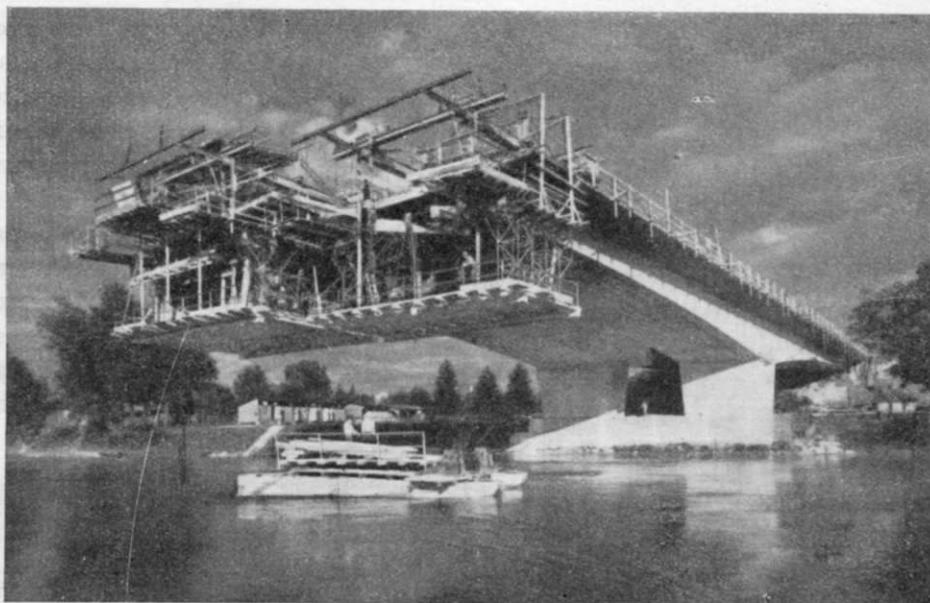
Ponte Ring Ulm: ponte a telaio, Costruzione ad avanzamento a sbalzo.
